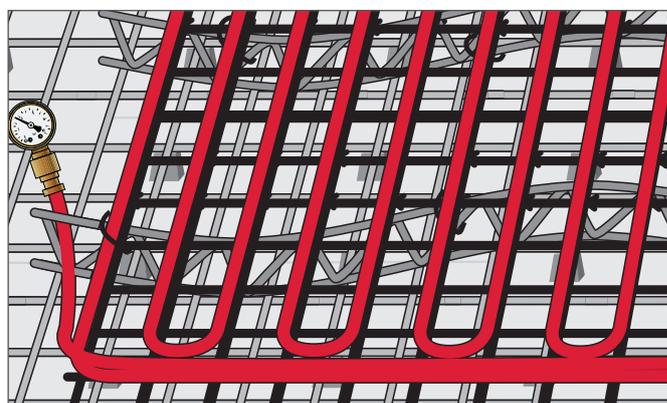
Punto 4 - Esecuzione della prova a pressione
